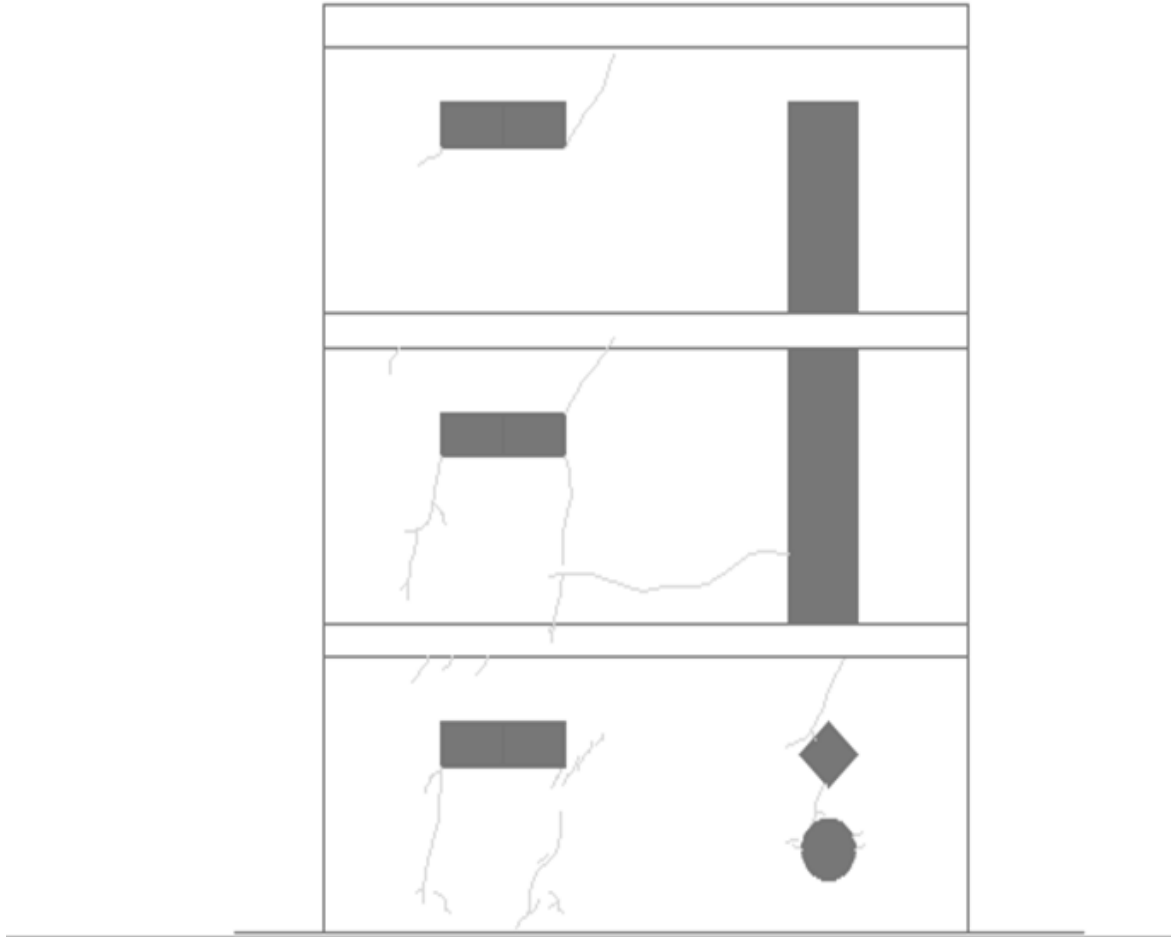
Esquema de Grietas Fachada 3. Realizada por el autor.
